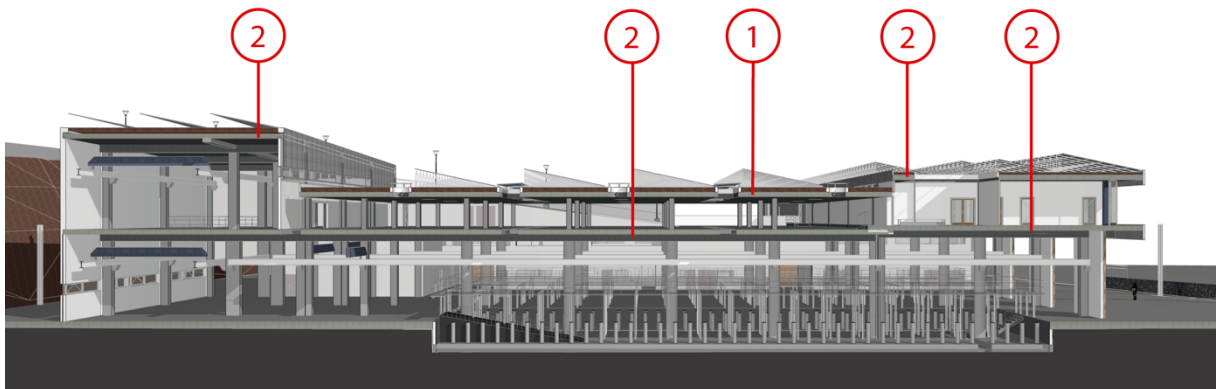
Sección Fugada. Tipos de Cubiertas del edificio. 1- Cubierta ecológica; 2 Cubierta plana invertida.
